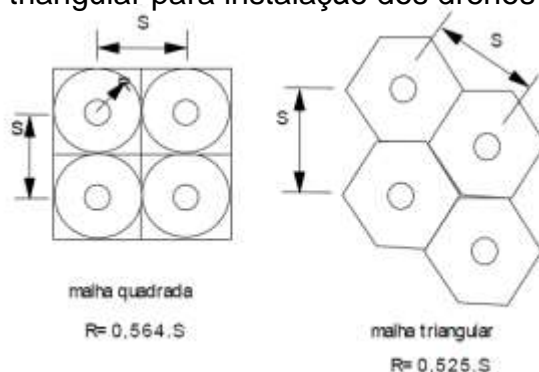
Configuração de malhas típicas para drenos verticais
